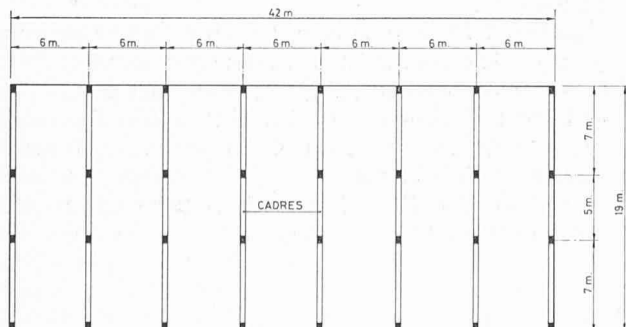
Structure linéaire : cadres multiples à étages. Disposition en plan.
